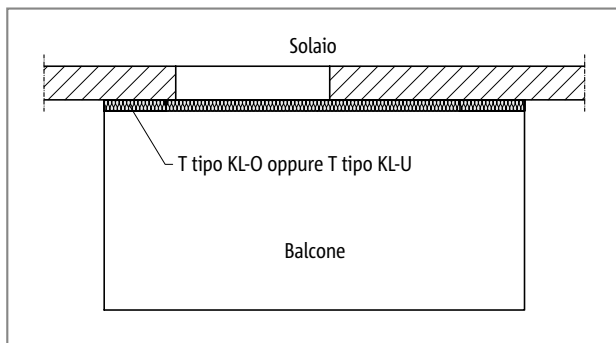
Schöck Isokorb® T tipo KL-O/KL-U: balcone a sbalzo
